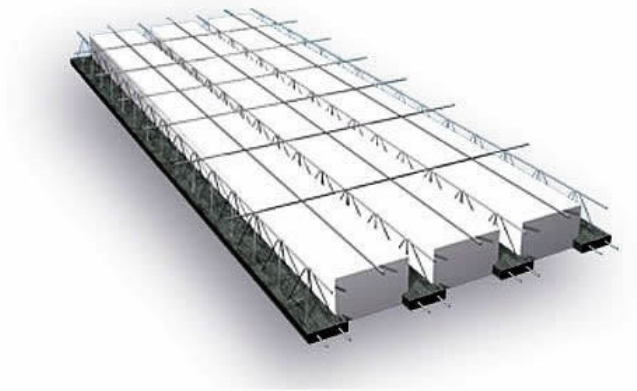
Armadura de distribuição presente na capa de concreto
